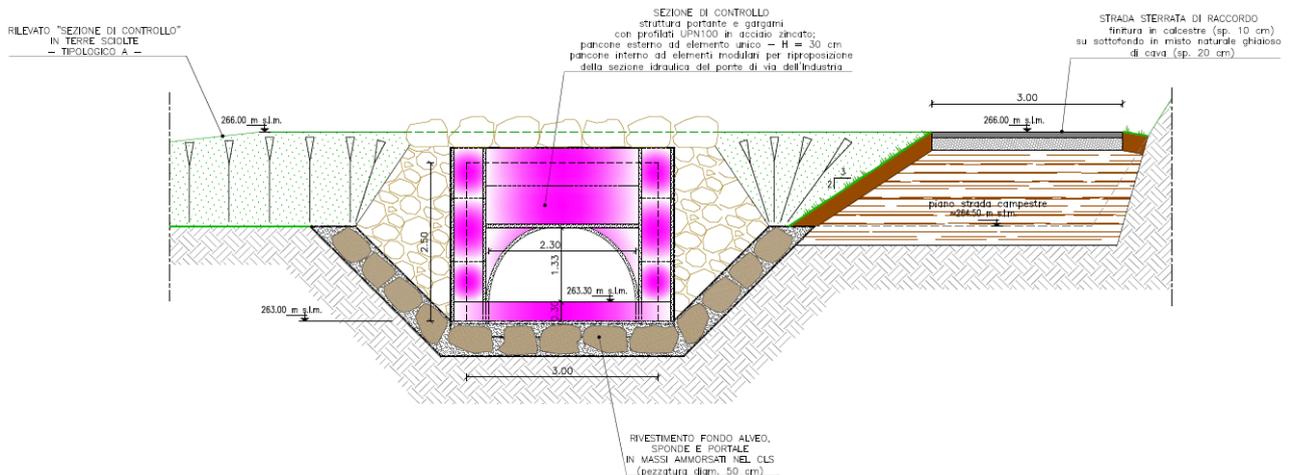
Vista in sezione della sezione di controllo in progetto sul Fosso dei Pascoli
